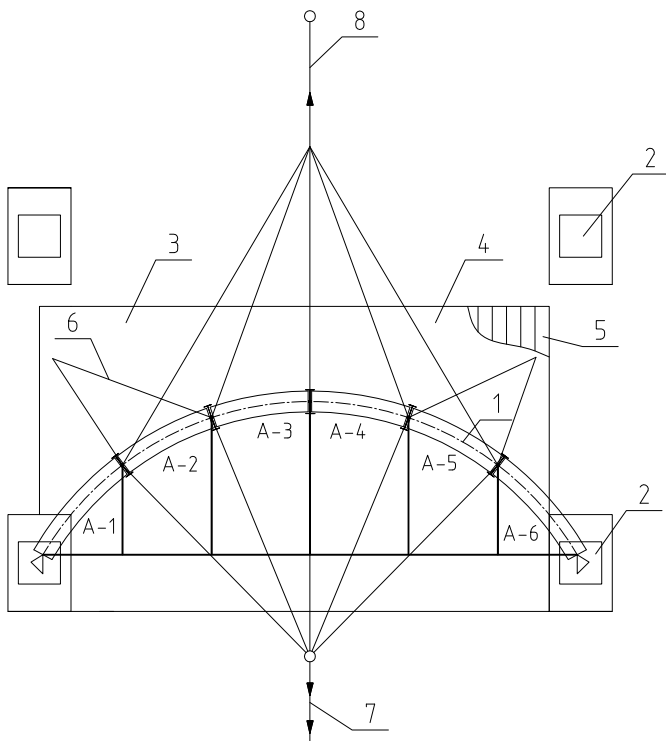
Схема монтажа арок на сплошных подмостях:
